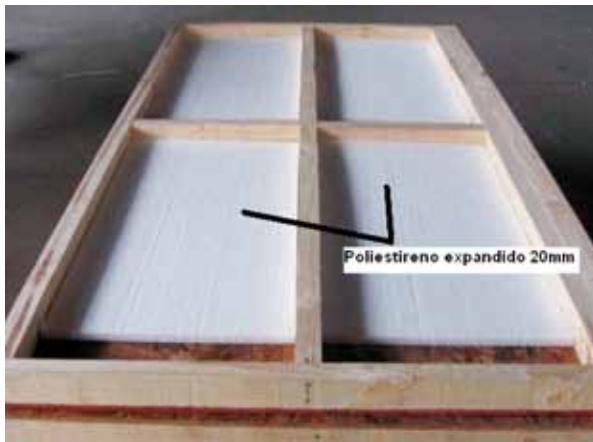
Estructura de piso, compuesta de vigas de 2 x 6'' impregnadas con sales CCA y contrachapados estructurales de 18 mm
